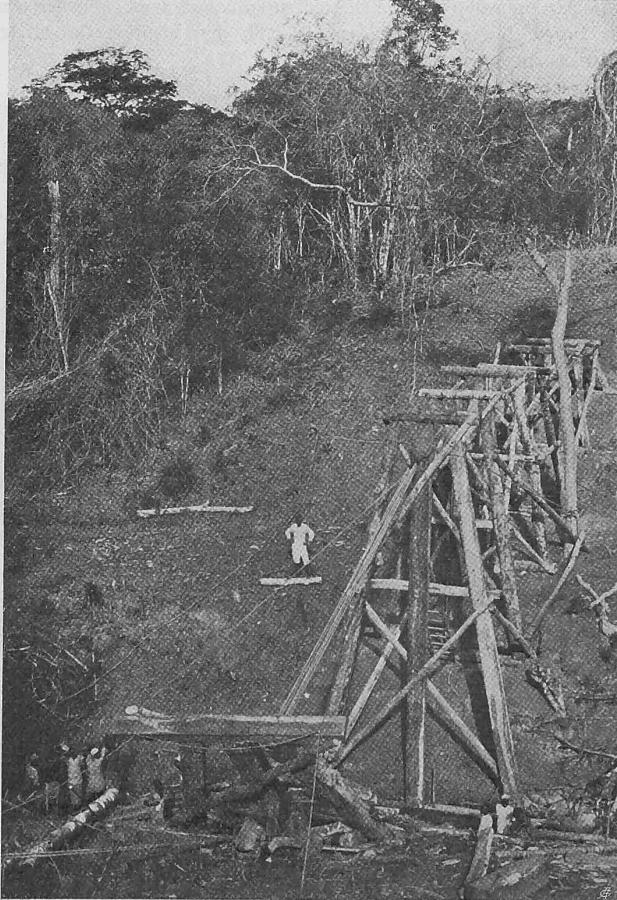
Dienstbrückenbau zur Umfahrung einer Baustelle bei Km. 24.
